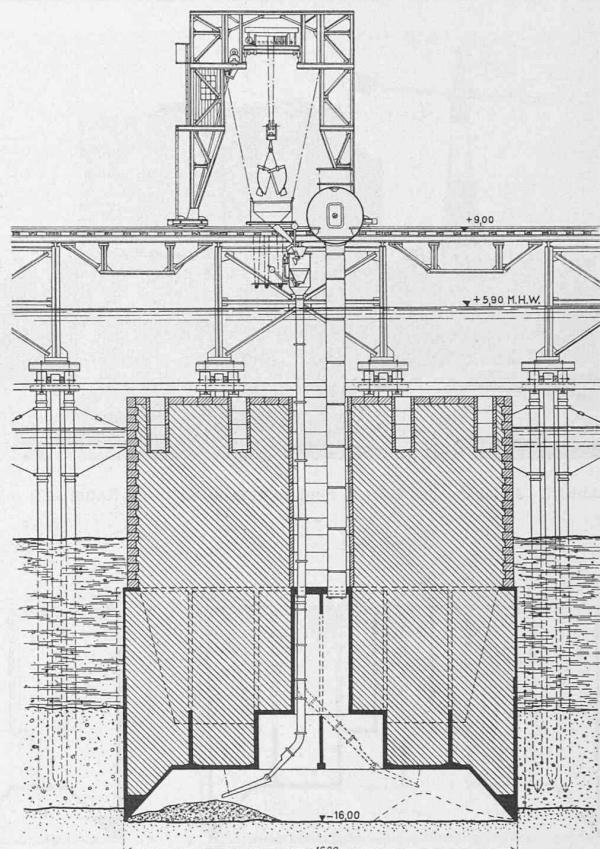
Anordnung für das Ausbetonieren der Arbeitskammer; Längsschnitt 1:300 durch den Senkkasten. Dahinter Dienstbrücke und Bockkran mit Fülltrichter zur Betonschleuse.
